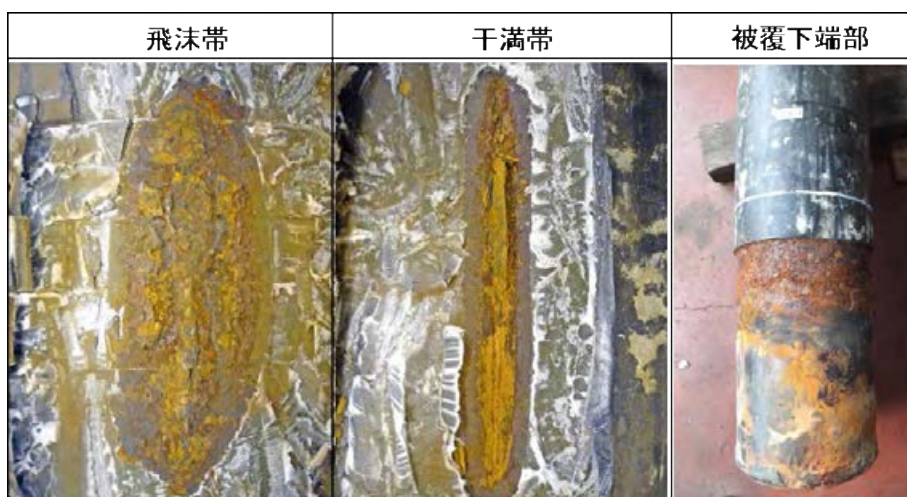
人工欠陥部からの錆状況と下端部の状況
